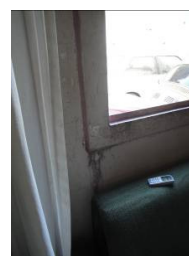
Infiltração no canto da esquadria e placa fissurada.
